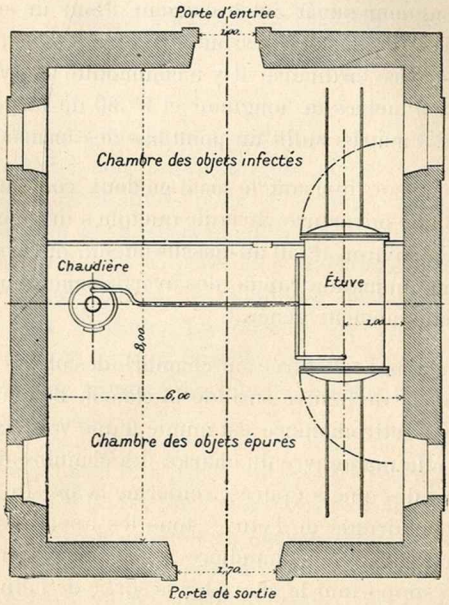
Installation dans un lazaret, un hôpital ou un établissement public, d'une étuve fixe à désinfection par la vapeur sous pression, système breveté Geneste et Herscher. — Vue en plan.
